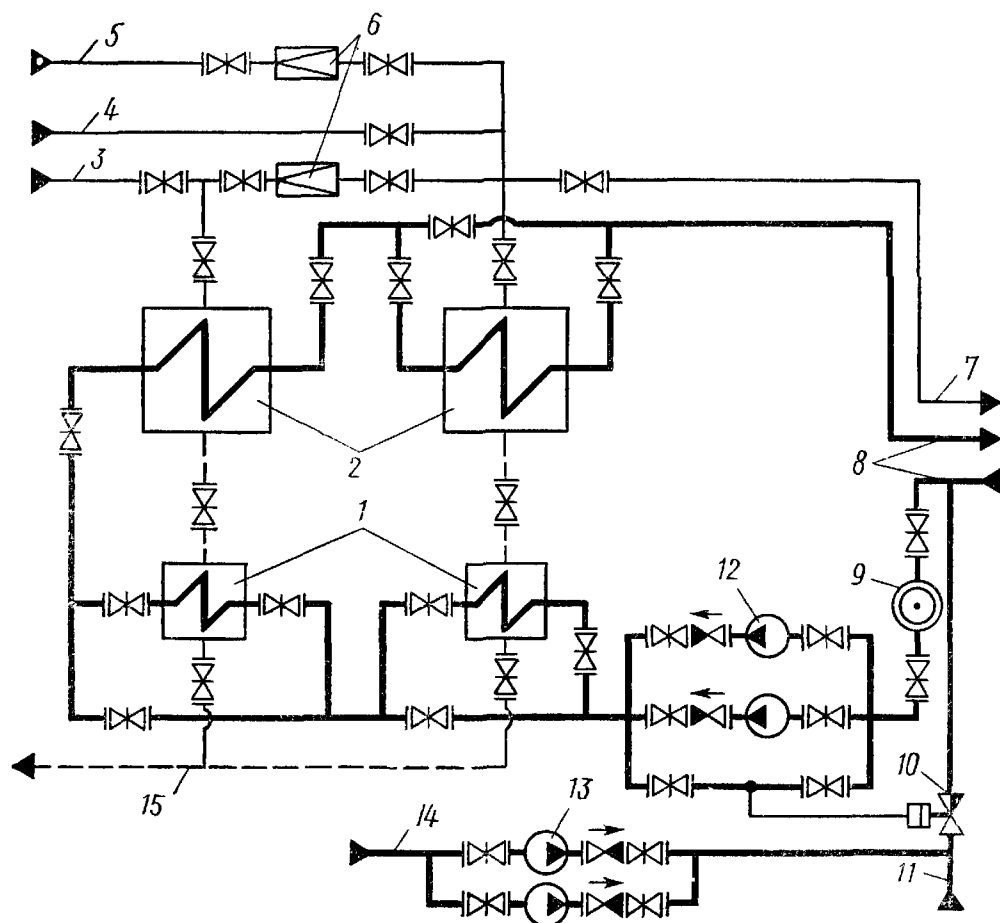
Схема водоподогревательной установки ТЭЦ при двухтрубной системе теплоснабжения:
